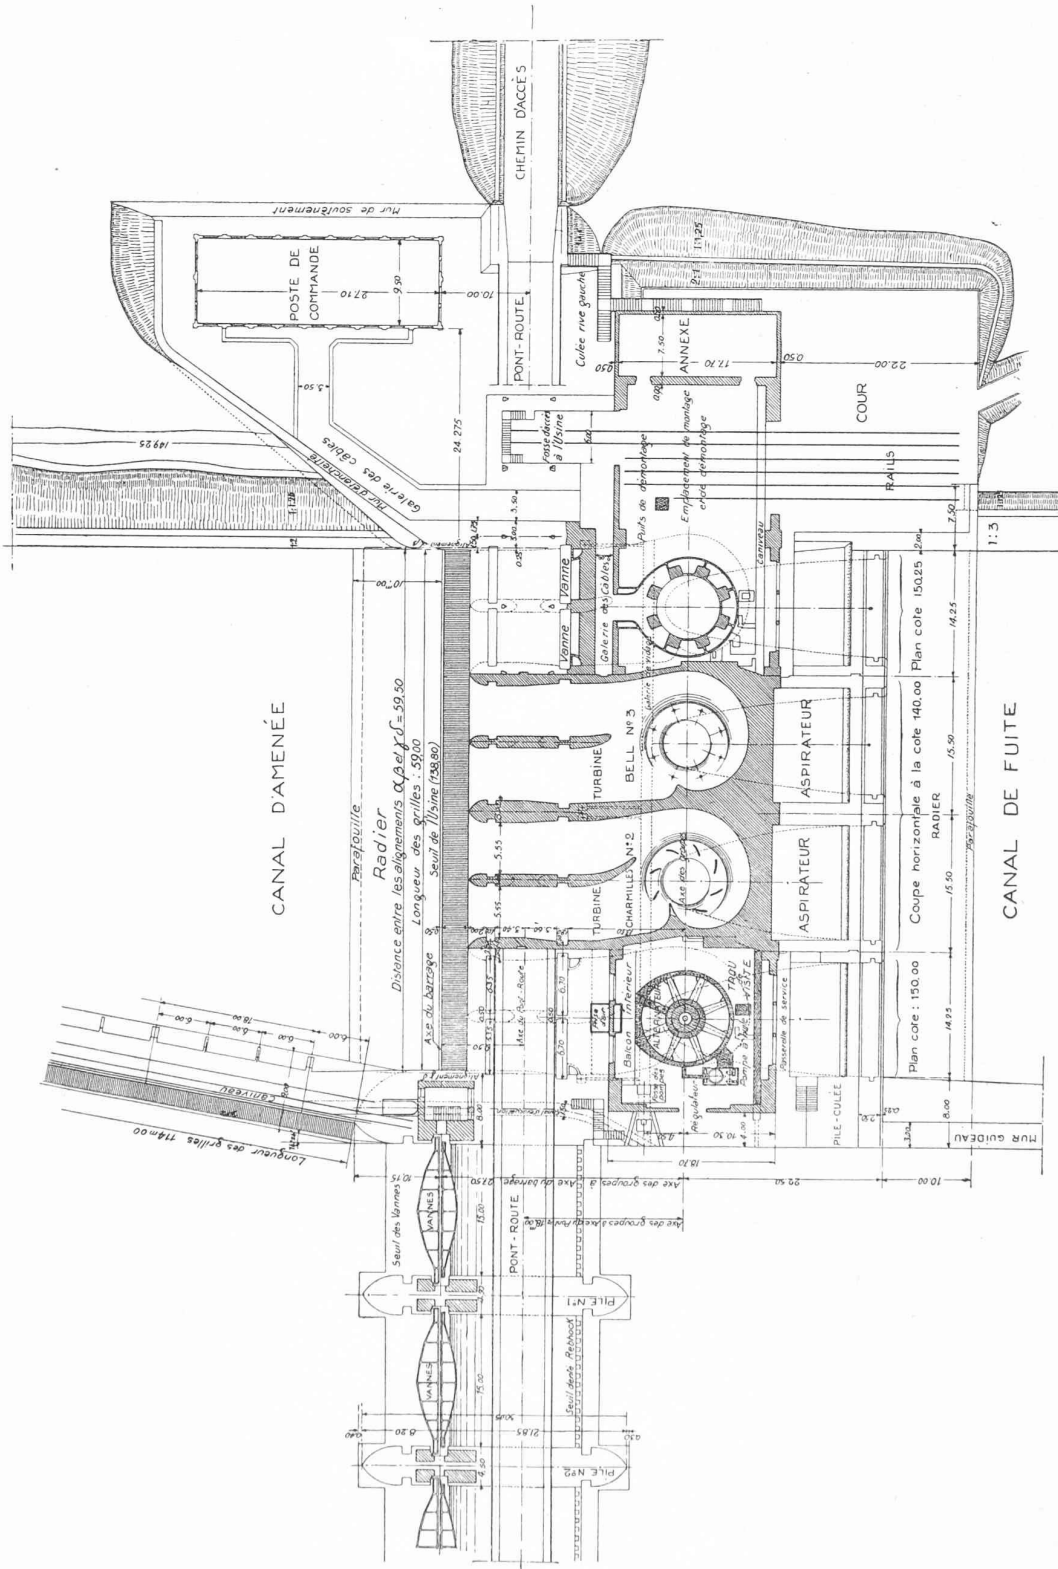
Plan général de l'usine de Pizanzon. — Echelle 1 : 800.
